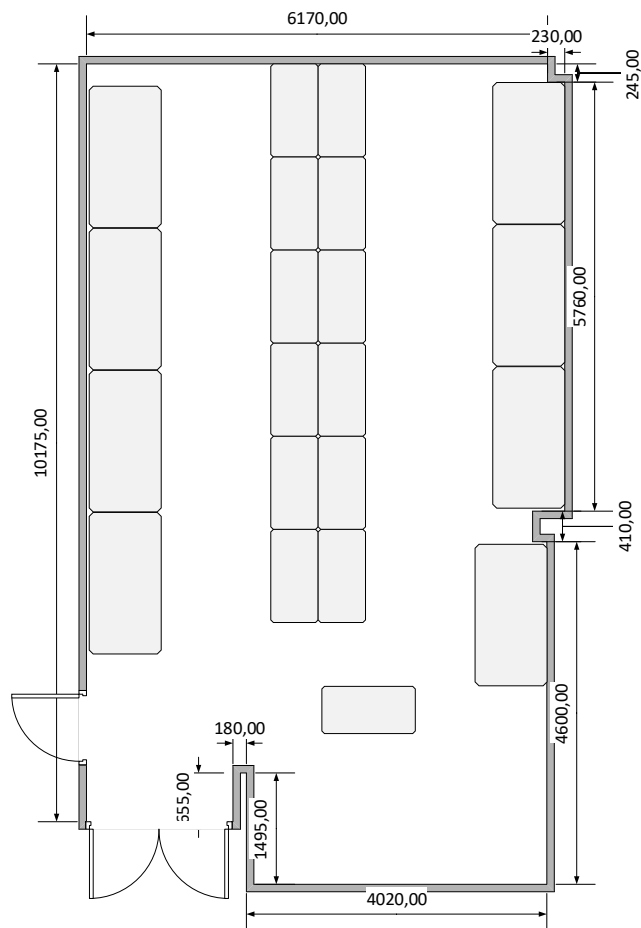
Plano del laboratorio de ingeniería eléctrica 06-A-3.
